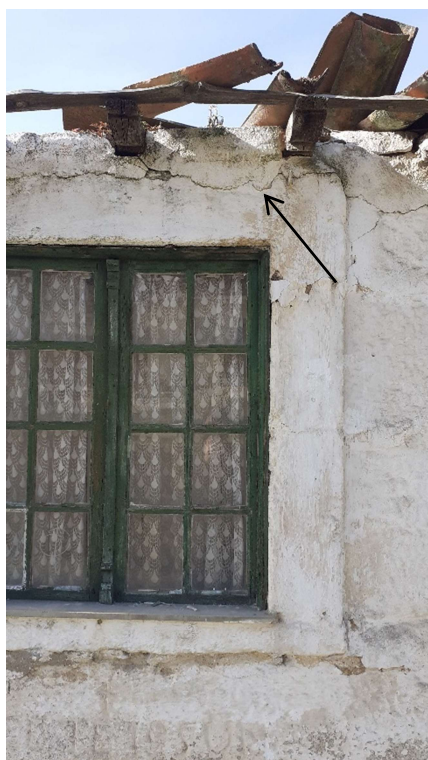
Fissura horizontal na parede do alçado principal do edifício.
